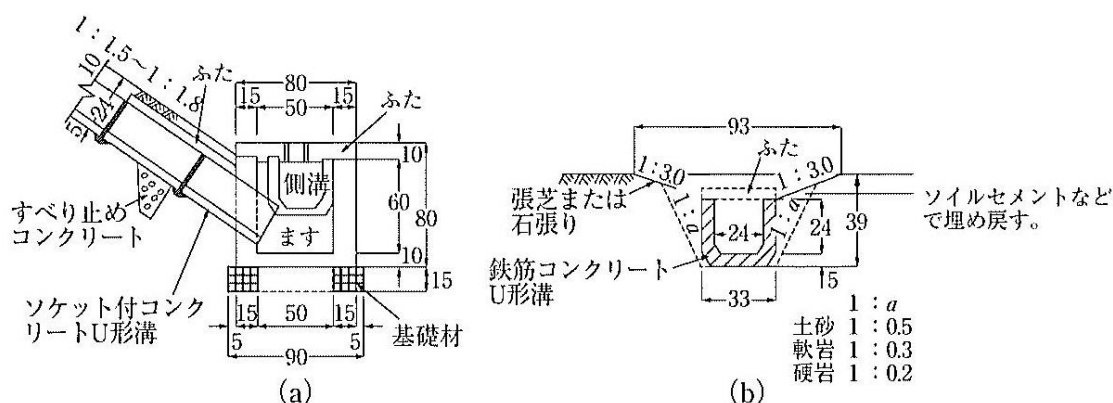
鉄筋コンクリート U 形溝による縦排水溝の設置例(単位:cm)
